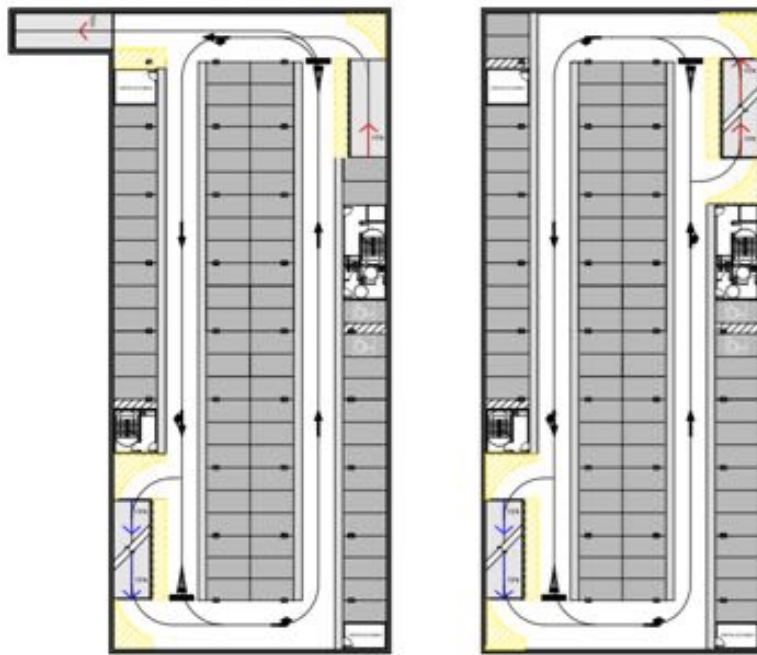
Ubicación de las rampas - Alternativa 2 Plano
